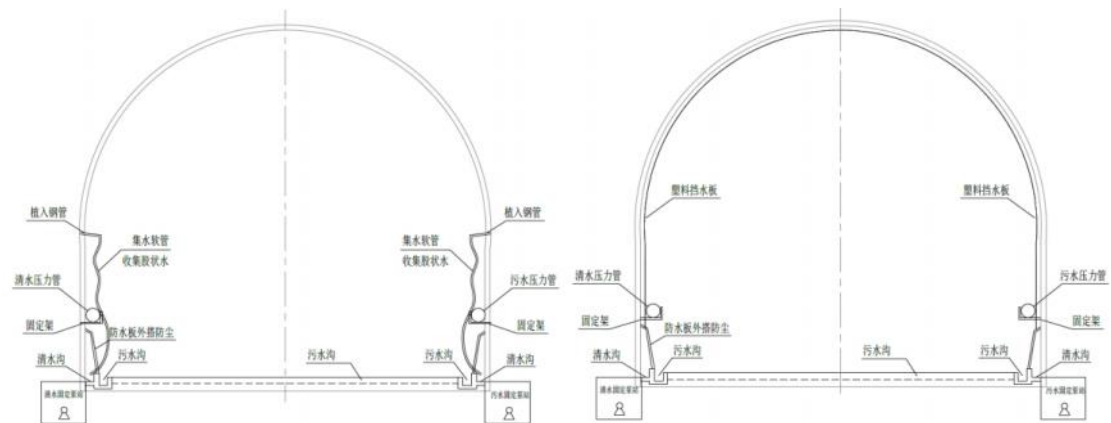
钻爆法反坡初支段清污分流横断面图
